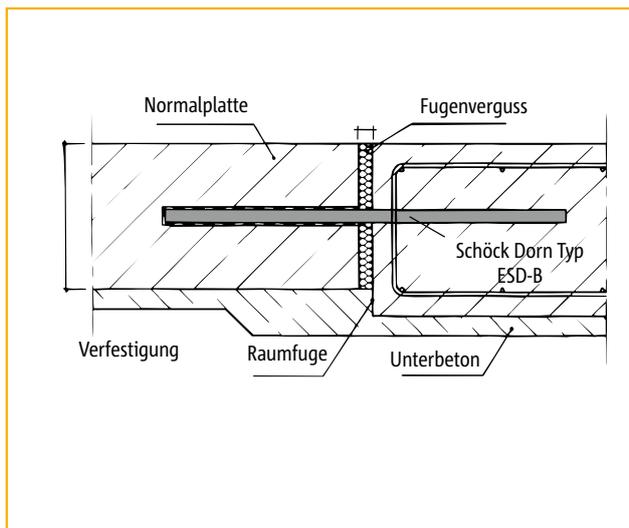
Anschlüsse von Betonfahrbahnen an Brückenbauwerken (mit Schlepp-Platten-Konstruktionen)
